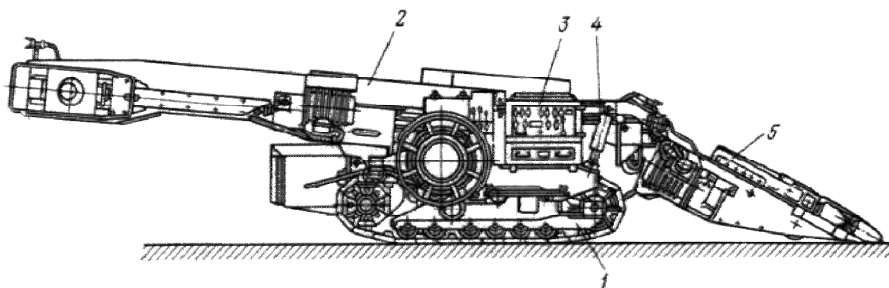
Общий вид и основные узлы погрузочной машины ПНБ-4: 1 – гусеничный ход; 2 – скребковый конвейер; 3 – электрооборудования; 4 – гидросистема; 5 – исполнительный орган
